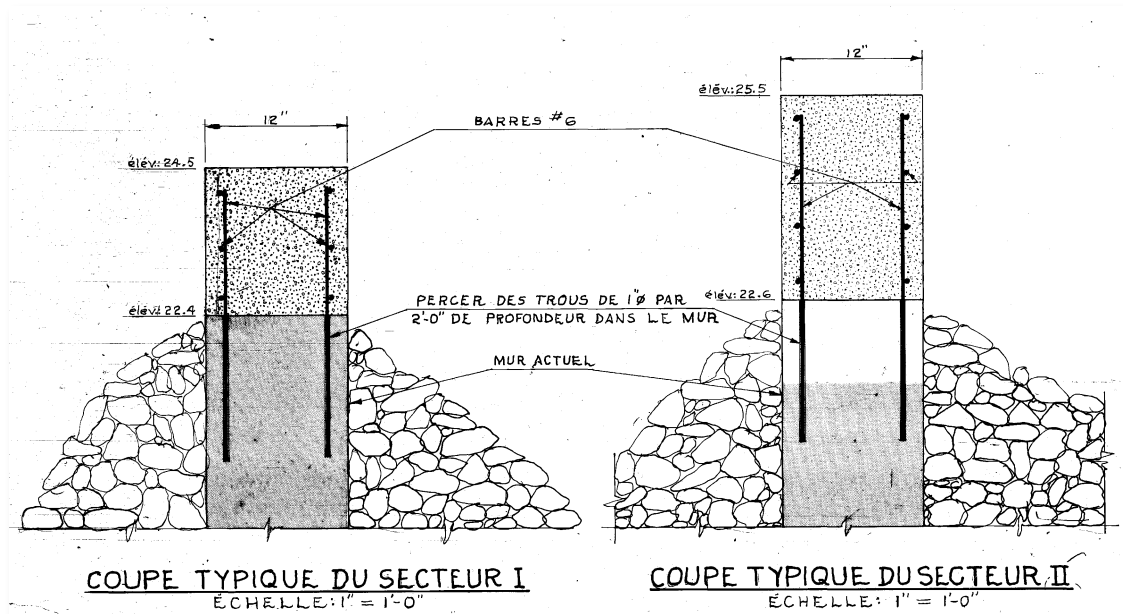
Extrait d'un plan figurant les travaux faits en 1974 pour le rehaussement du mur de protection longeant en rive gauche la rivière du Gouffre près de la rue Ménard à Baie-Saint-Paul
